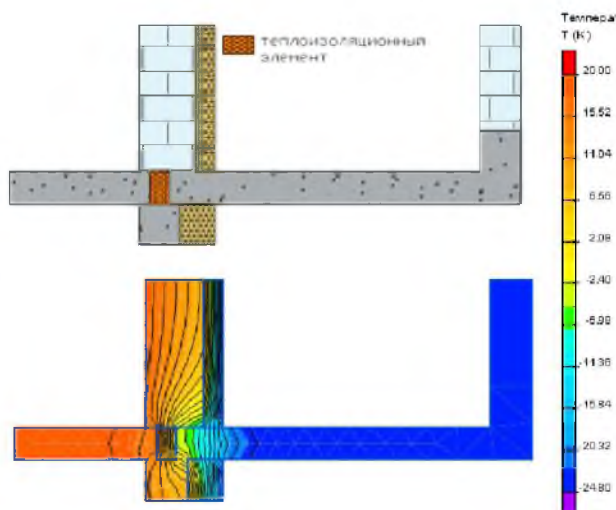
Эскиз сечения конструкции и распределение температурных полей в сечении узла при использовании теплоизоляционного элемента в зоне сопряжения балкона и плиты перекрытия /
